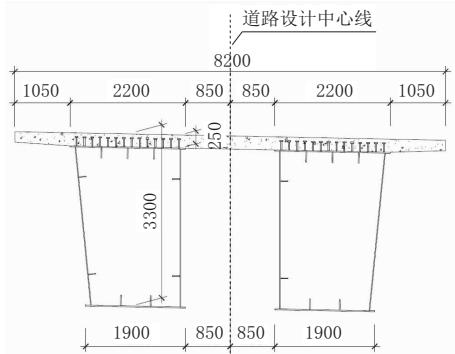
匝道 65m 简支组合梁横断面图(单位:mm)
